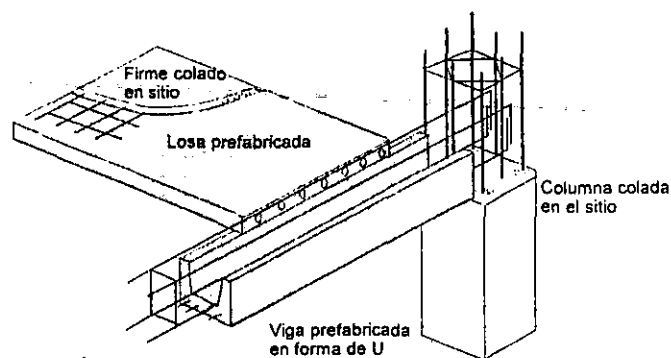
Conexión viga-columna ensayada por Bull y Park
